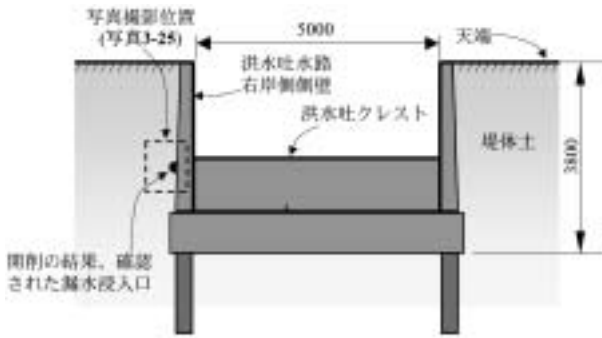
洪水吐の横断面図と開削の結果発見された漏水浸入口
